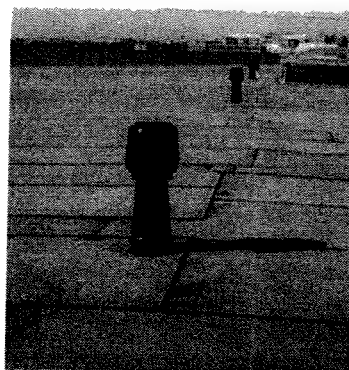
Внешний вид флюгарок (азраторов) после установки
